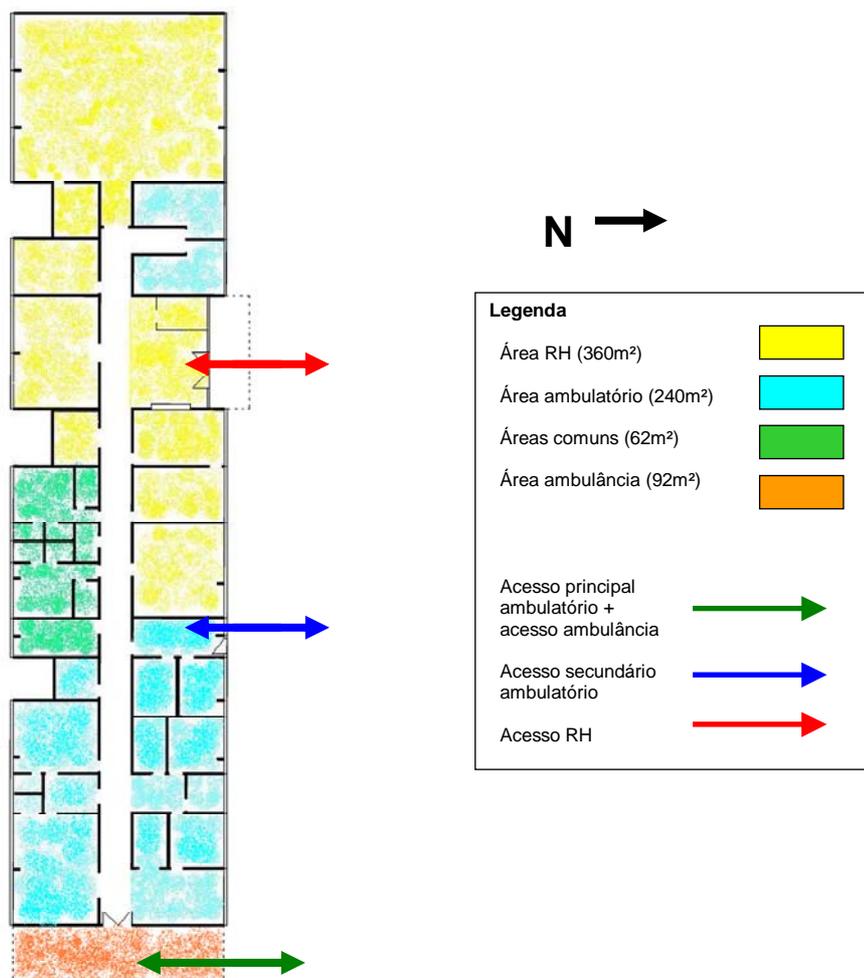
Planta baixa com a identificação dos acessos e áreas da edificação
